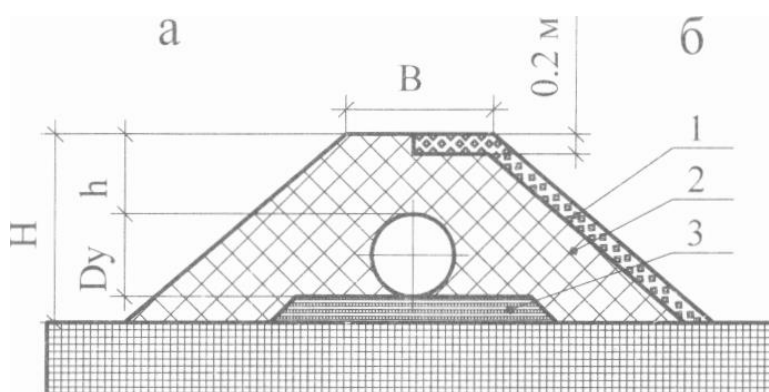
Конструкция насыпи при наземной прокладке трубопровода:
